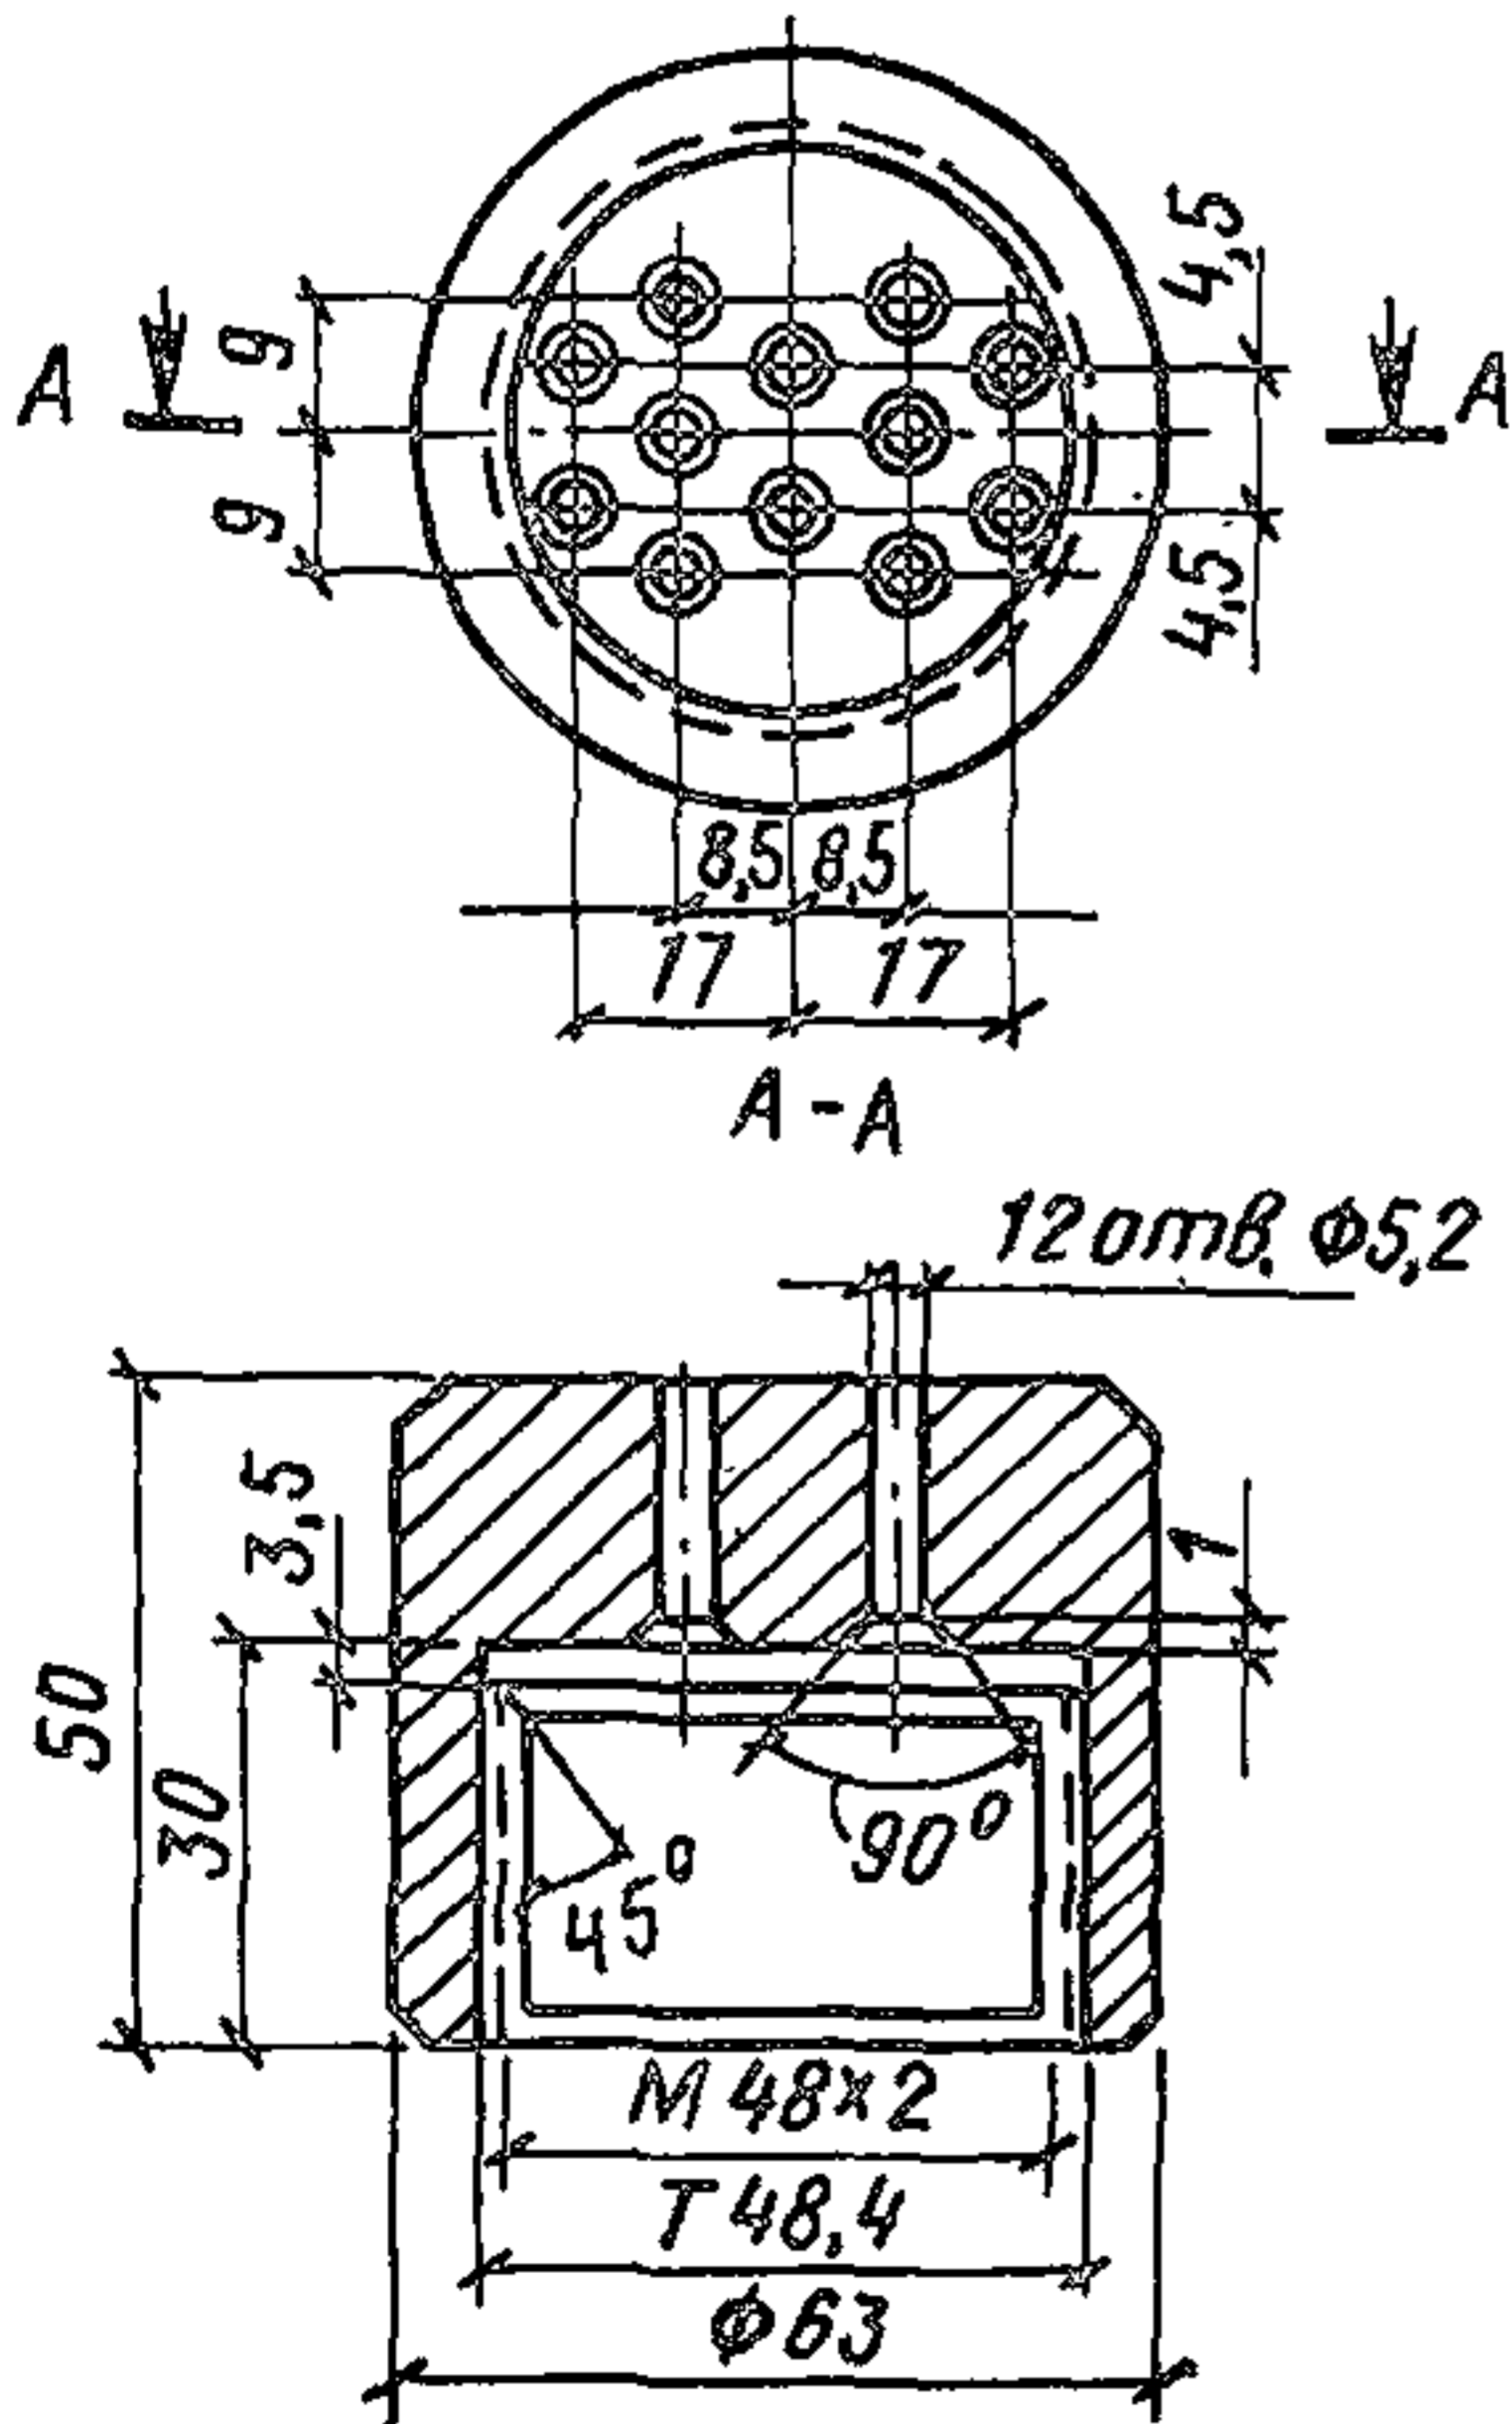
Анкерная колодка станочного типа АКС-12/5 для натяжения на бетон арматурного элемента (УНАЭ) из высокопрочной проволоки с высаженными головками
